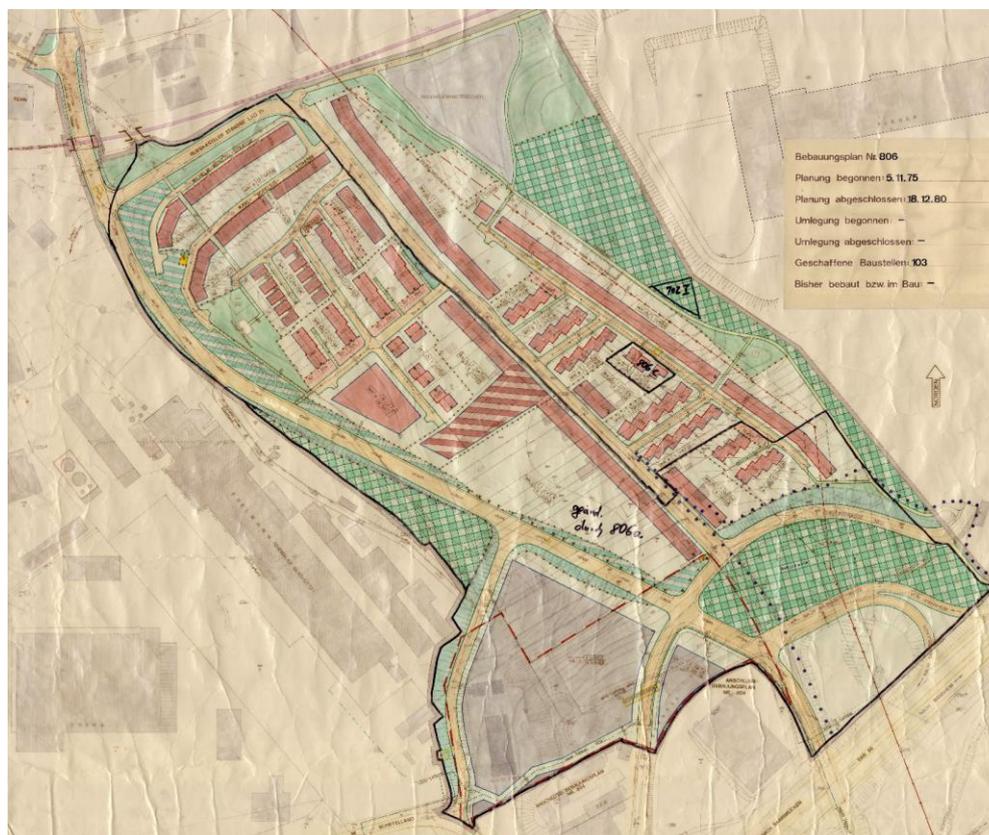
Bebauungsplan Nr. 806 „Obere Blieskasteler Straße“
